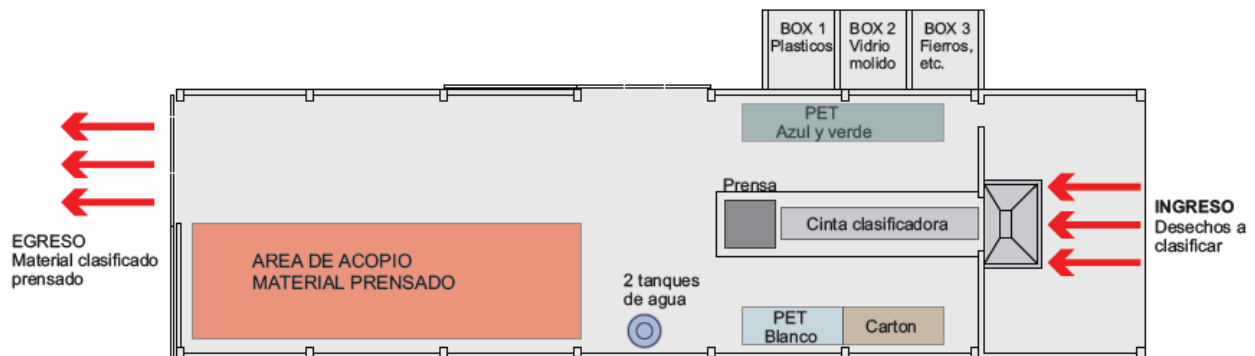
Diseño de la nueva planta de tratamiento de RSU (Arq. Joaquín Vanerio, 2021)
